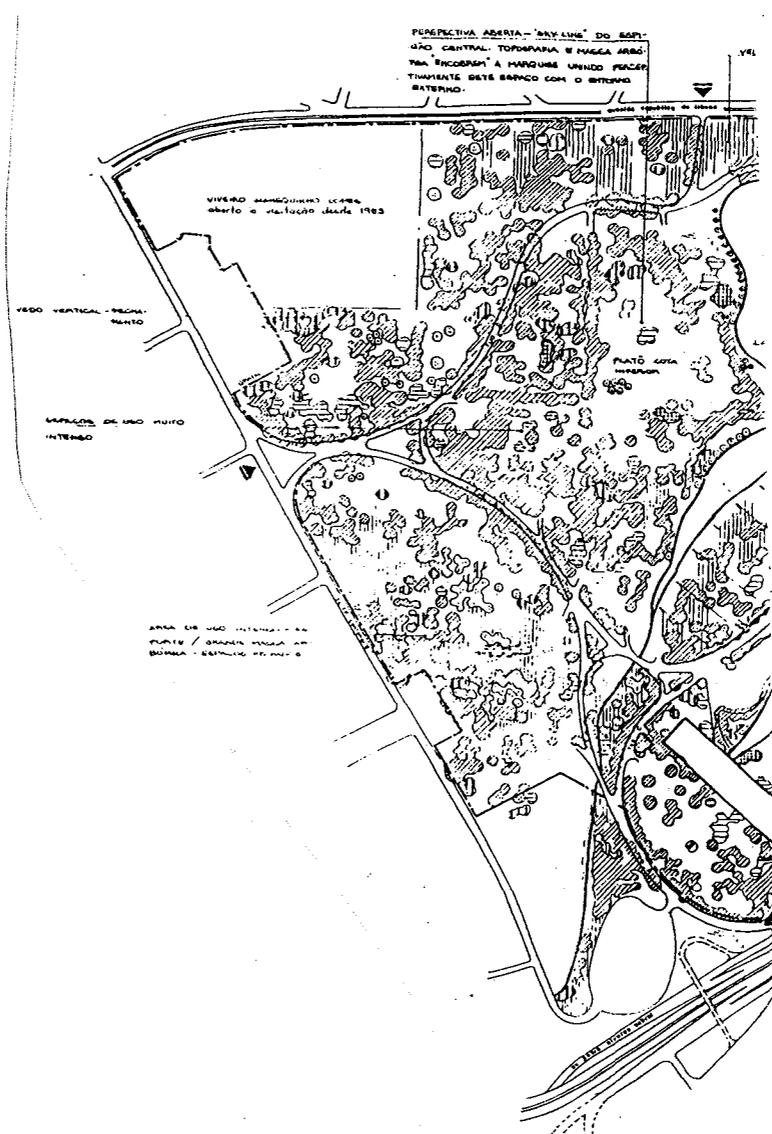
Parque Ibirapuera. Otávio Augusto Teixeira Mendes. São Paulo. 1953. Planta.
